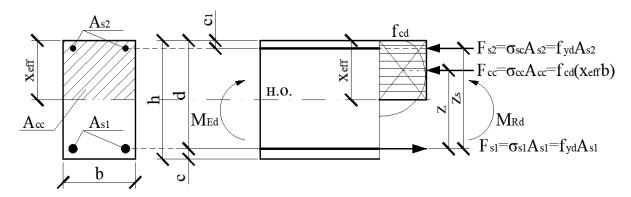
Расчетная схема элемента с двойным армированием
